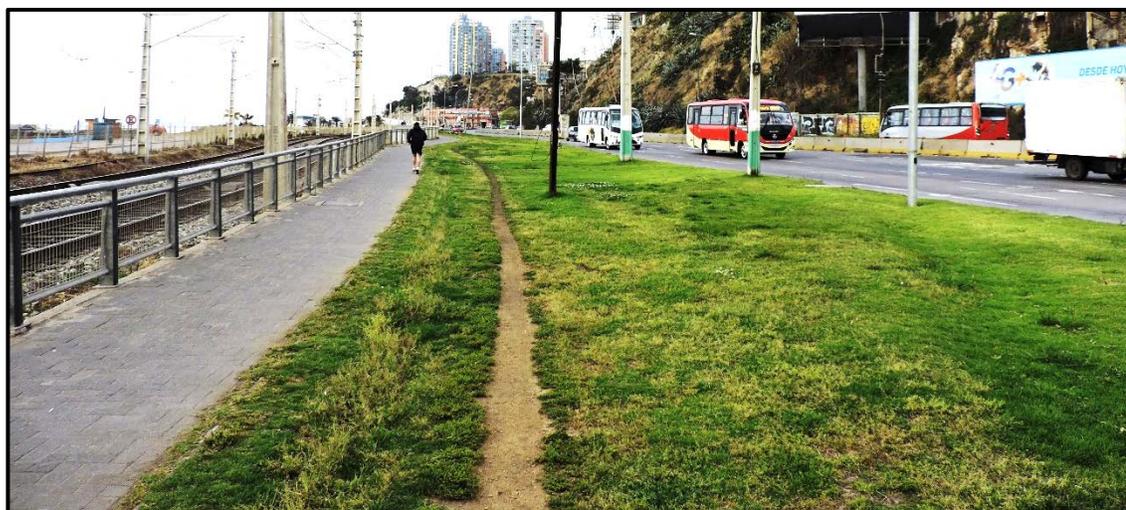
Fotografía Perfil Transversal Eje A (Av. España) / Sector A2 / 4
